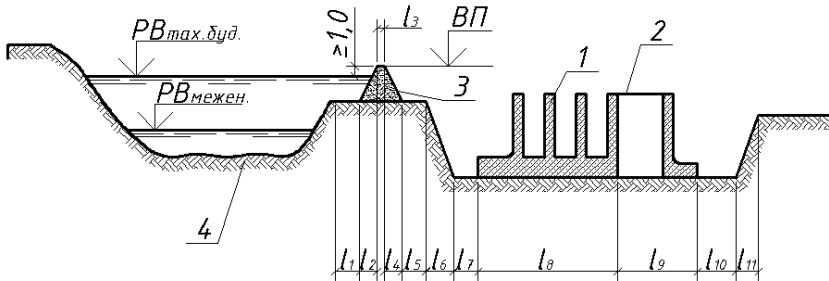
Схема розташування водоскидних споруд гідровузла на заплаві річки
